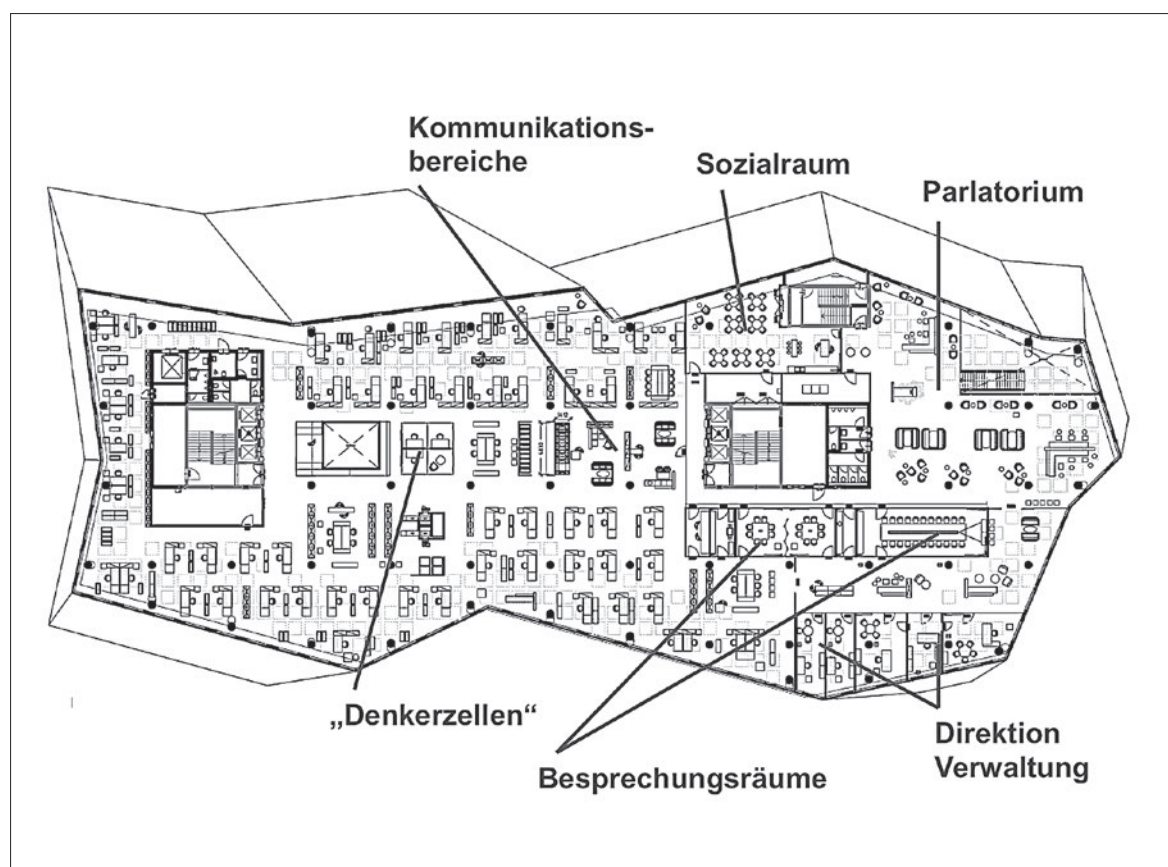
Grundriss des 5. Obergeschosses – Bibliotheksverwaltung
